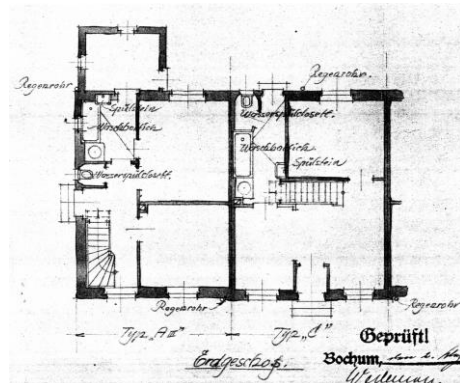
Grundriss Erdgeschoss, Typ A_{III} (l.) und Typ C (r.)
